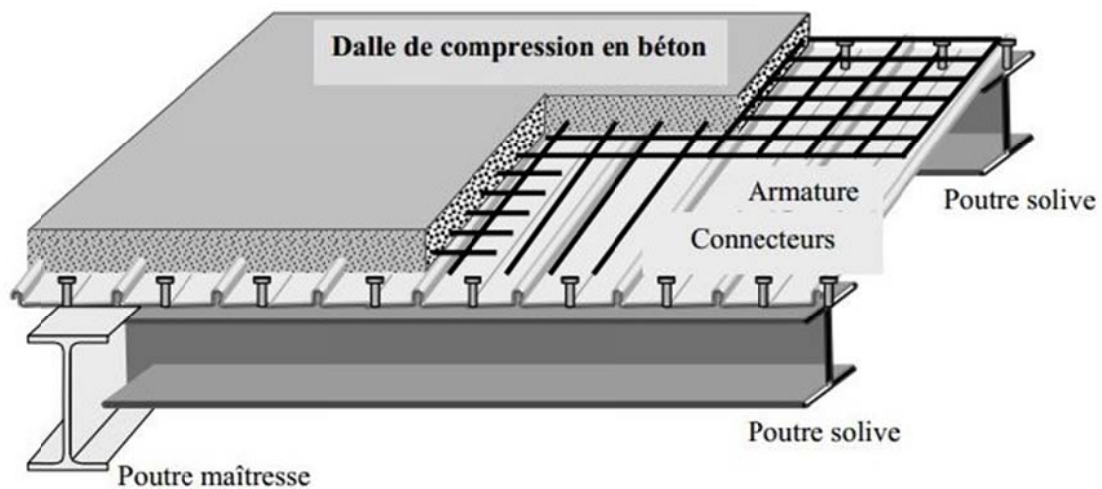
Les composants d'un plancher mixte (Acier-Béton)
